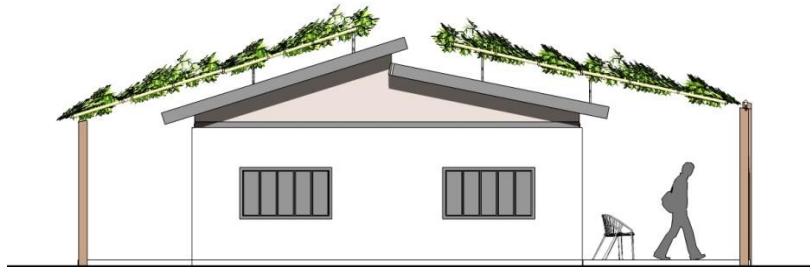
Corte Transversal – Cubierta con techo de chapas y pergolado con frondosa
